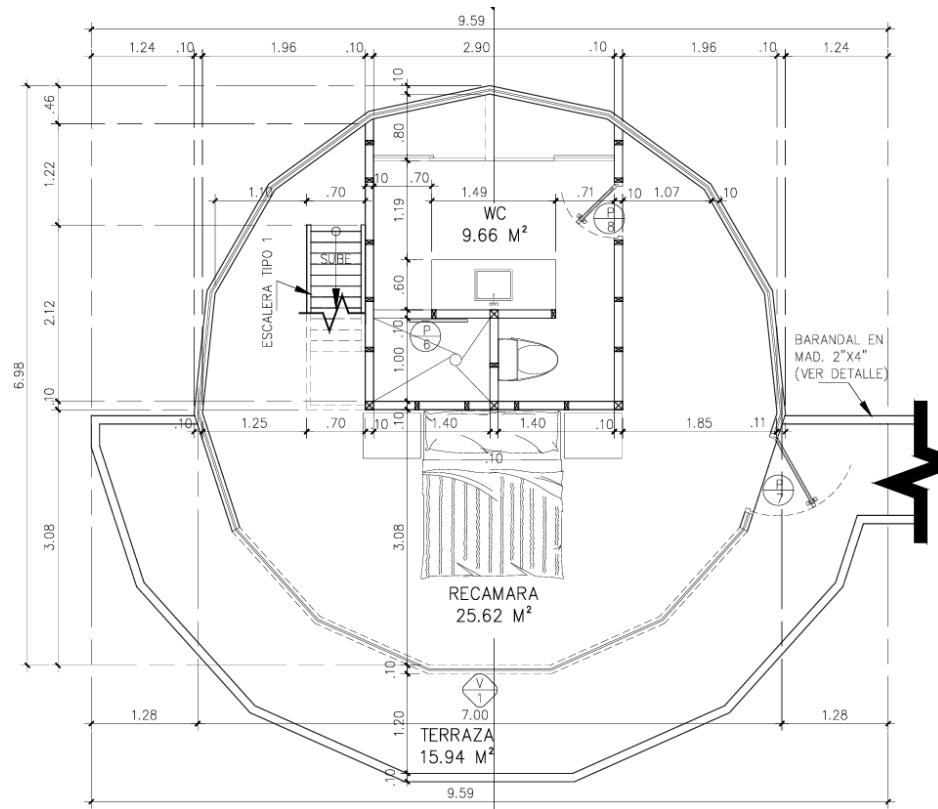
Vista en planta de dormitorio de 7 m de diámetro.
